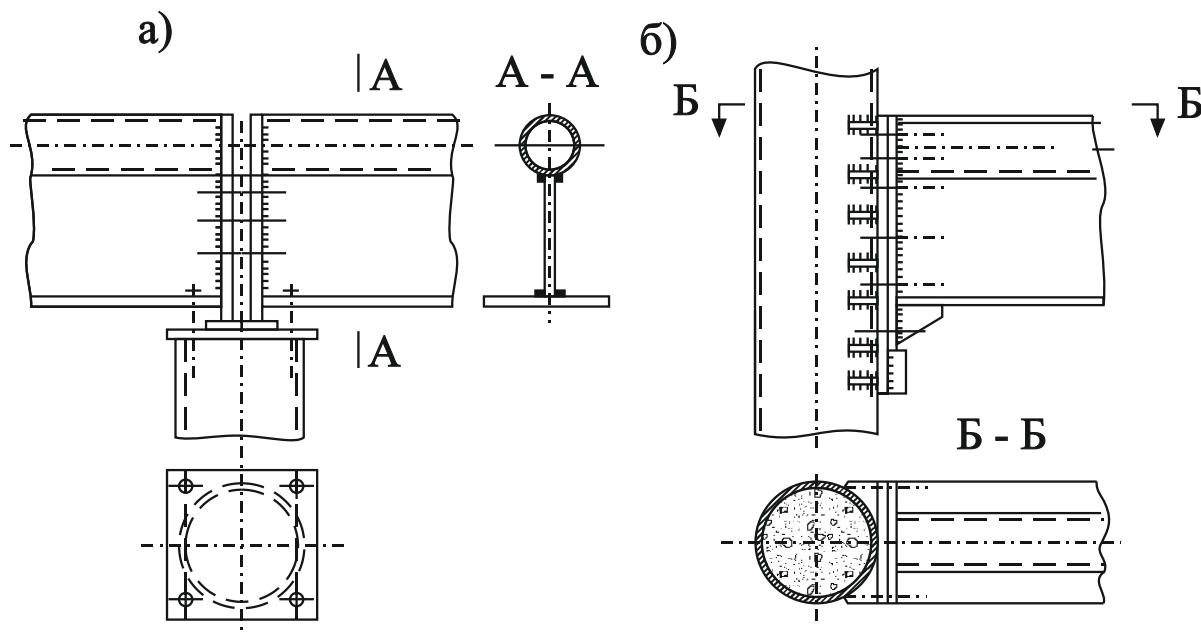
Сопряжение балки с трубобетонным верхним поясом с трубобетонной колонной при опирание балки сверху (а) и при примыкании сбоку (б)
